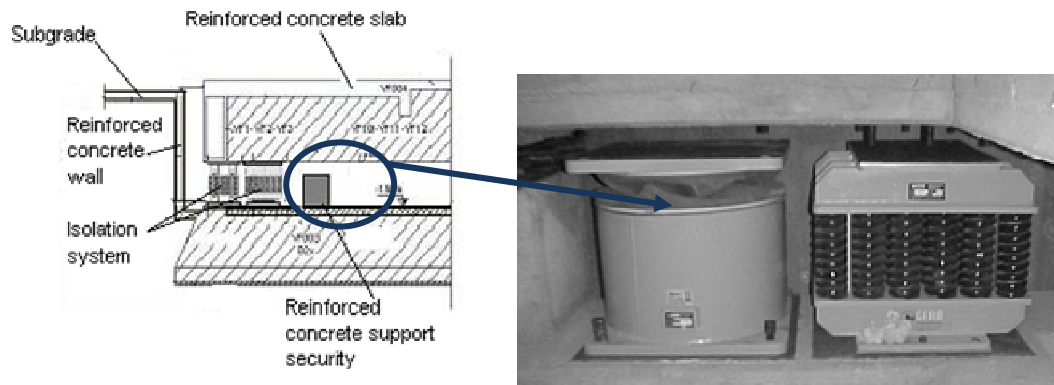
Posición relativa dispositivos de protección. Losa encima sistema de aislamiento sísmico
